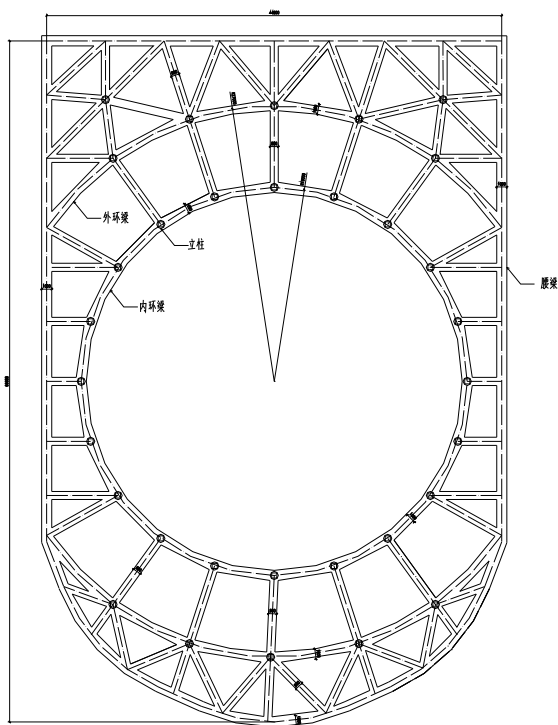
钢筋混凝土支撑体系平面示意图（第二道内支撑）
